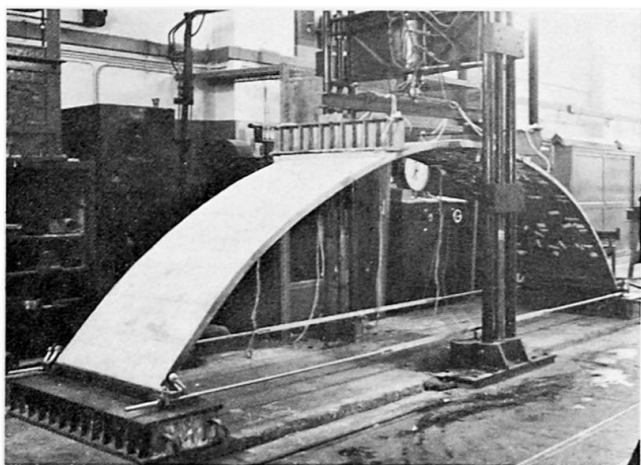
Essai d'une coque en béton plaqué. Portée 5,20 m. Flèche 1,30 m. Epaisseur 40 mm. Tôle de 2 mm.
